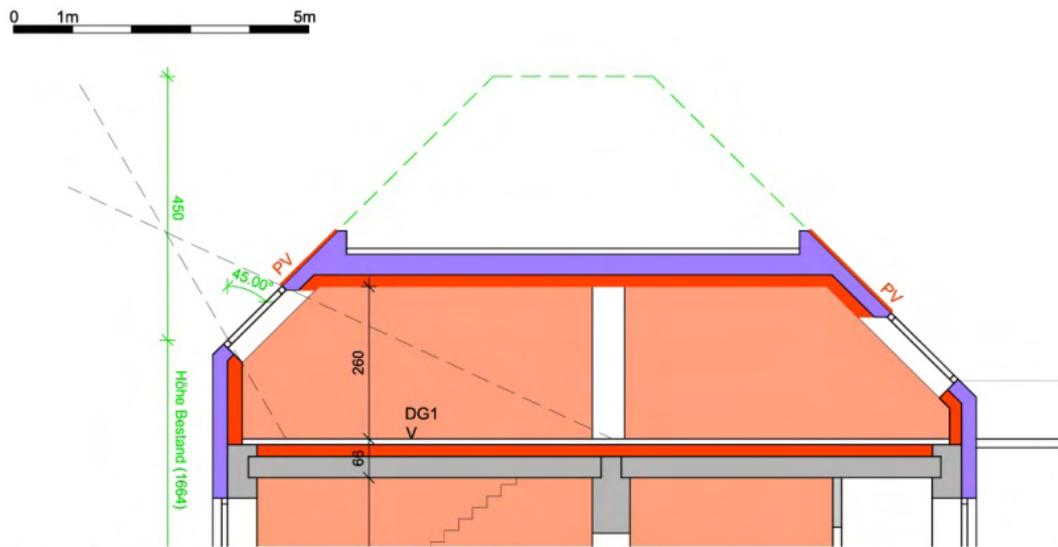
Schnitt AA durchs Dachgeschoss. Gablenzgasse
